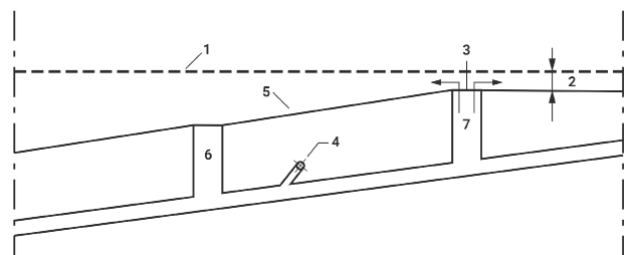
Definition Rückstauenebene bei abschüssigem Gelände = Höhe des Entspannungspunktes + Überstauhöhe (1 Rückstauenebene, 2 Überstauhöhe, 3 Oberkante Schacht = Entspannungspunkt, 4 Anschlusskanal Grundstücksentwässerung, 5 Gelände- bzw. Straßenoberfläche, 6 Schacht unten, 7 Schacht oben) (Quelle: Ishorst)
